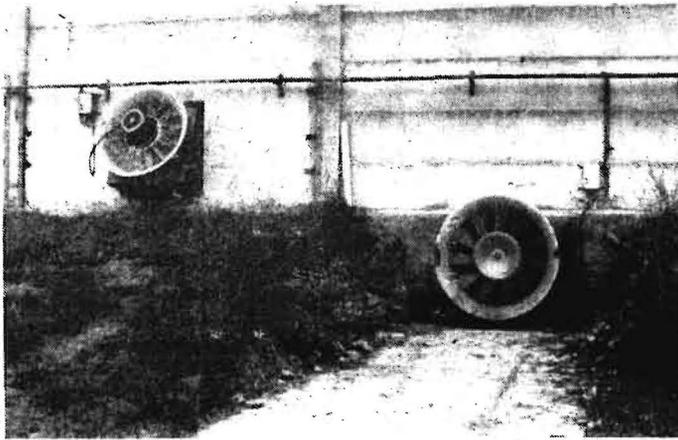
Ventilatorseite der Versuchsanlage; links 15-kW-Ventilator LANVR 1000 im Oberflureinbau, rechts 11-kW-Ventilator im Unterflureinbau
